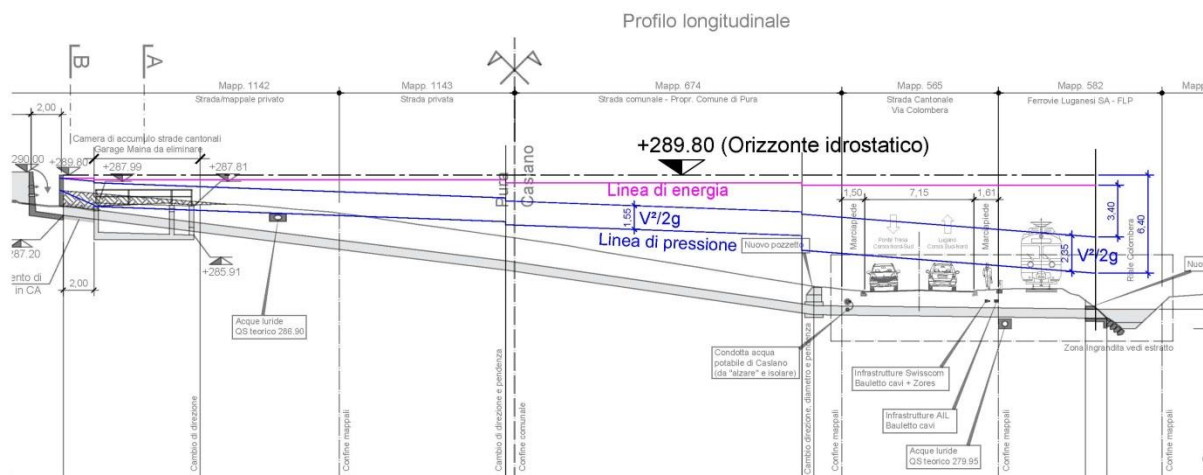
Sezione con linee di pressione condotta in pressione (estratto allegato 4)
